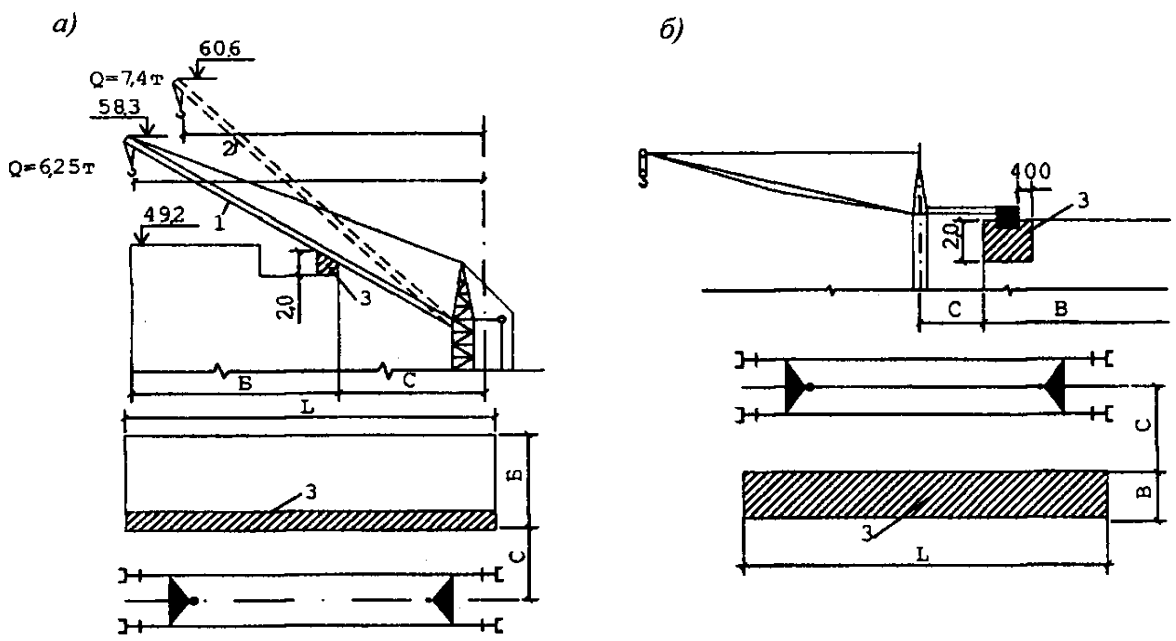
Опасные зоны при монтаже здания: а - при наибольшем вылете стрелы башенного крана; б - при перемещении противовеса на уровне монтажного горизонта; 1 - положение стрелы при наибольшем вылете; 2 - положение стрелы при наименьшем вылете; 3 - опасная зона
